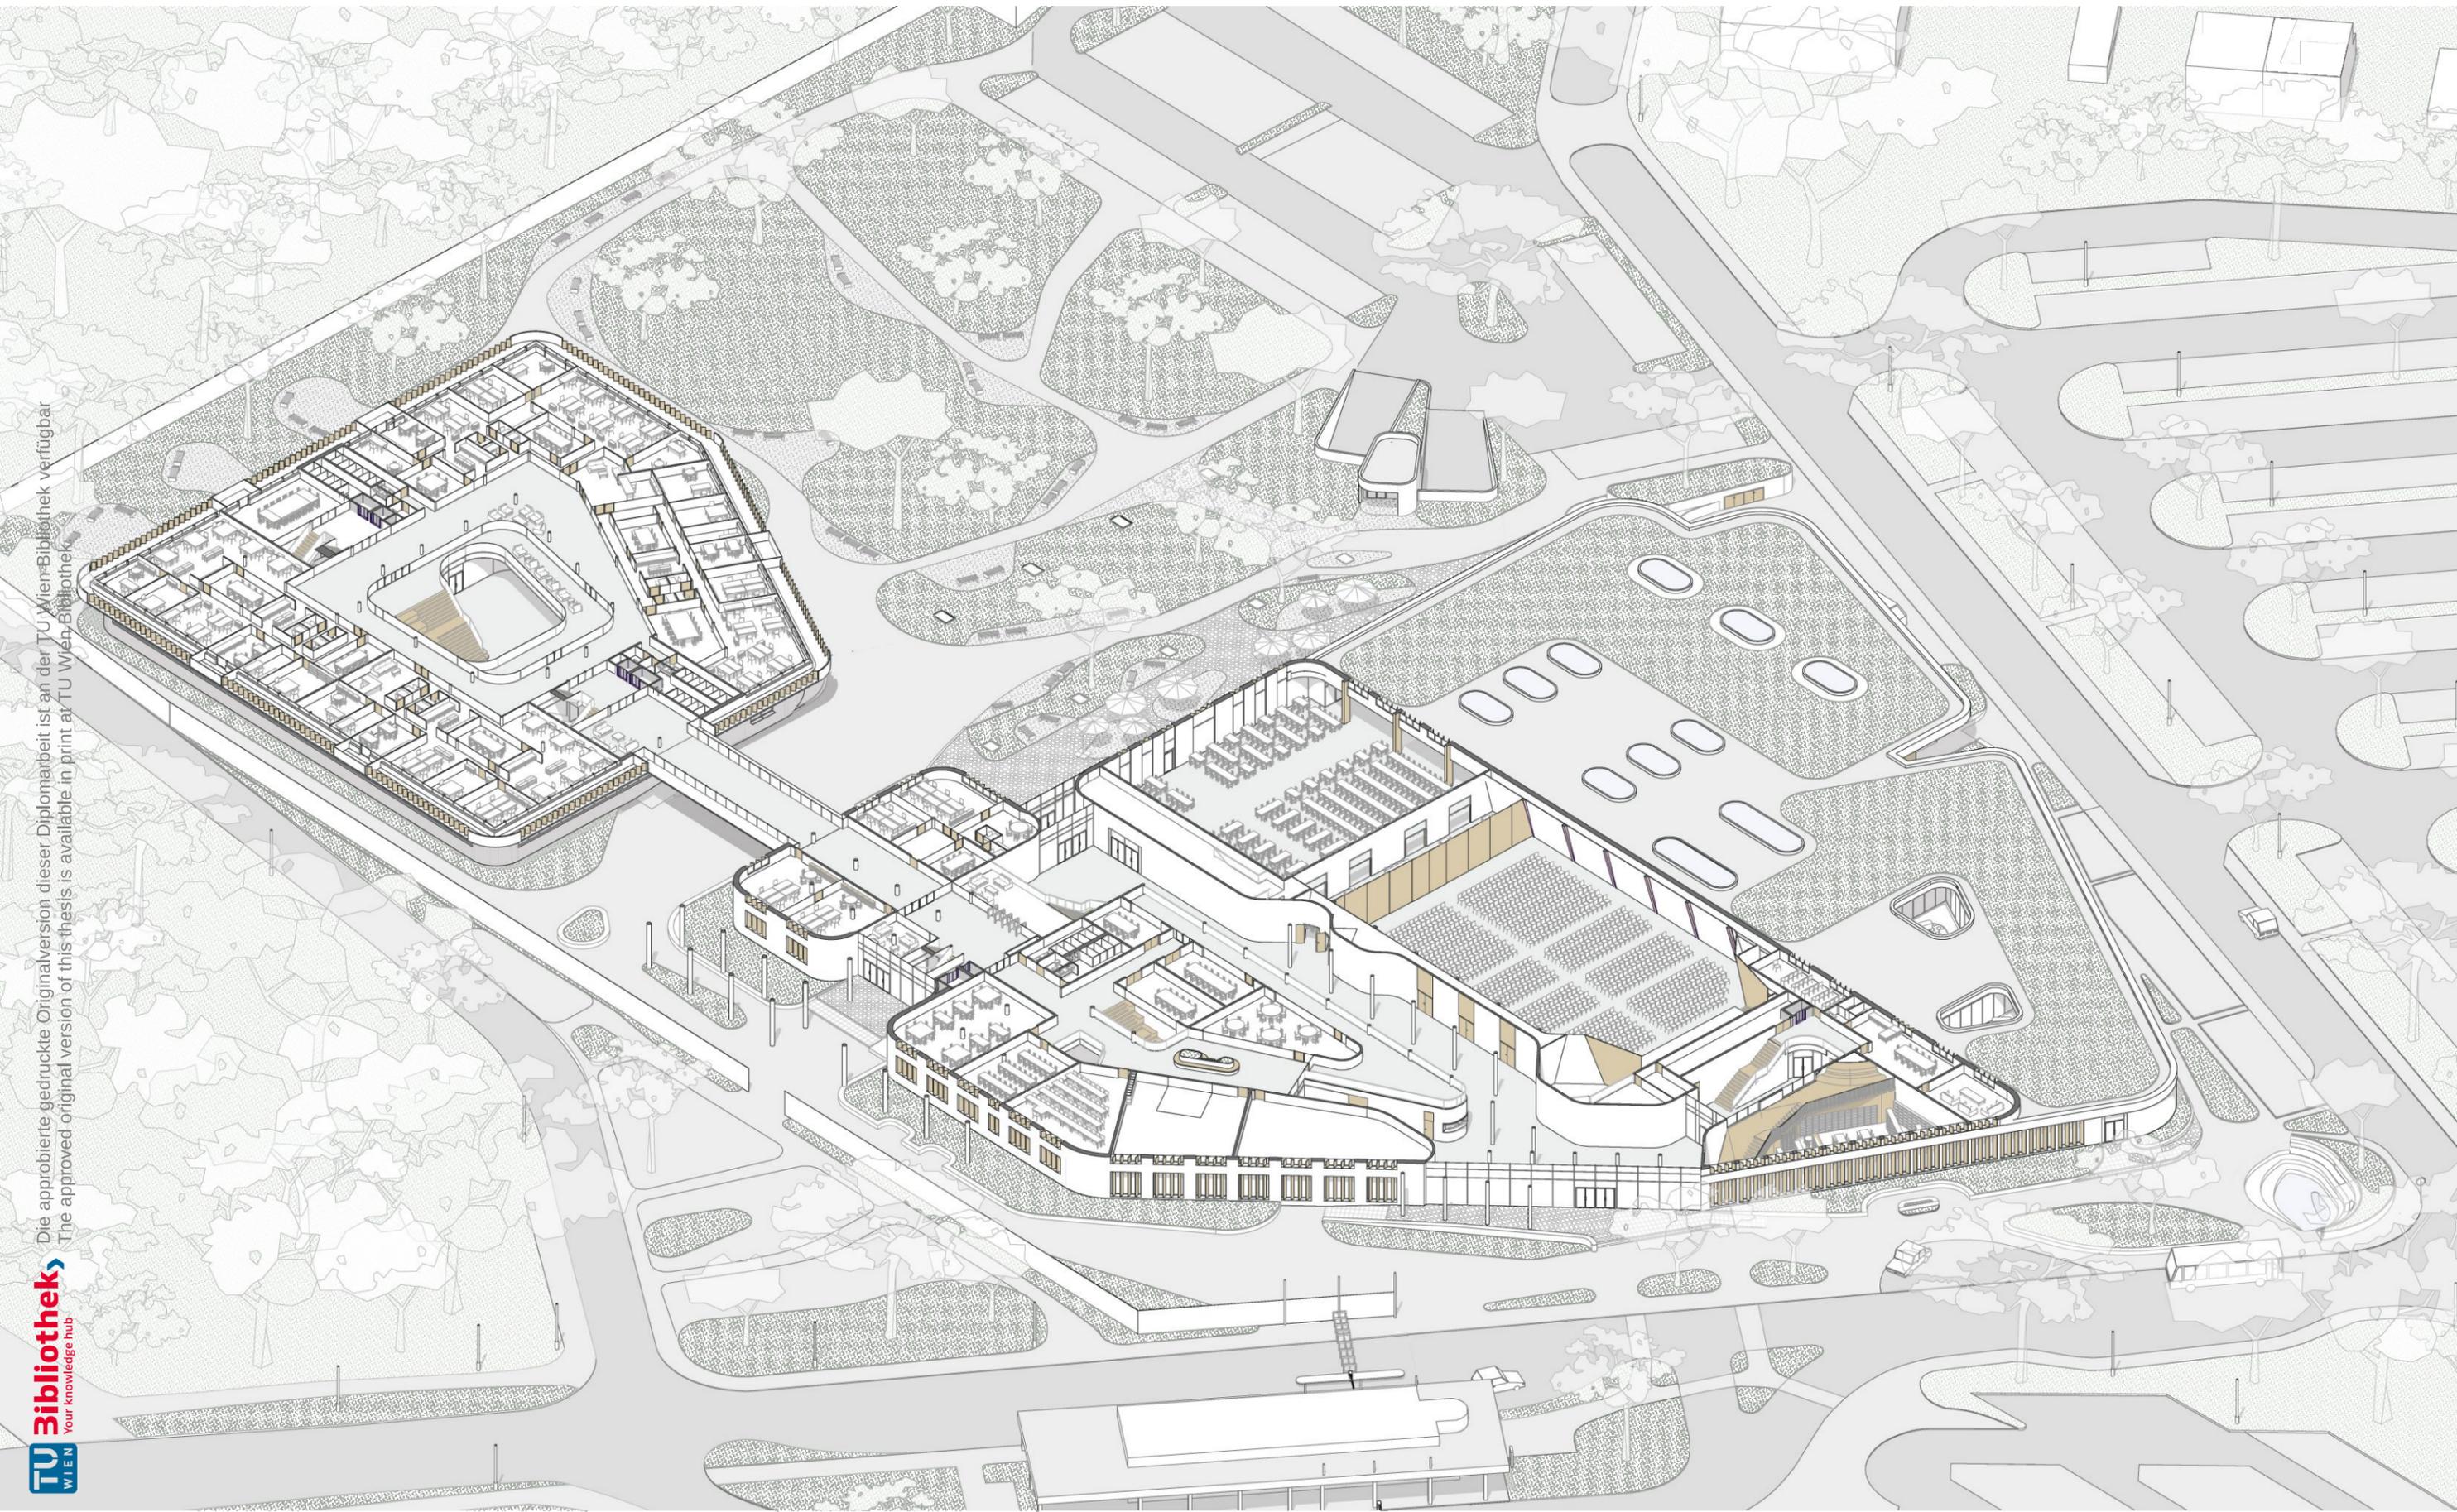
Grundriss 1.OG M: 1:500
